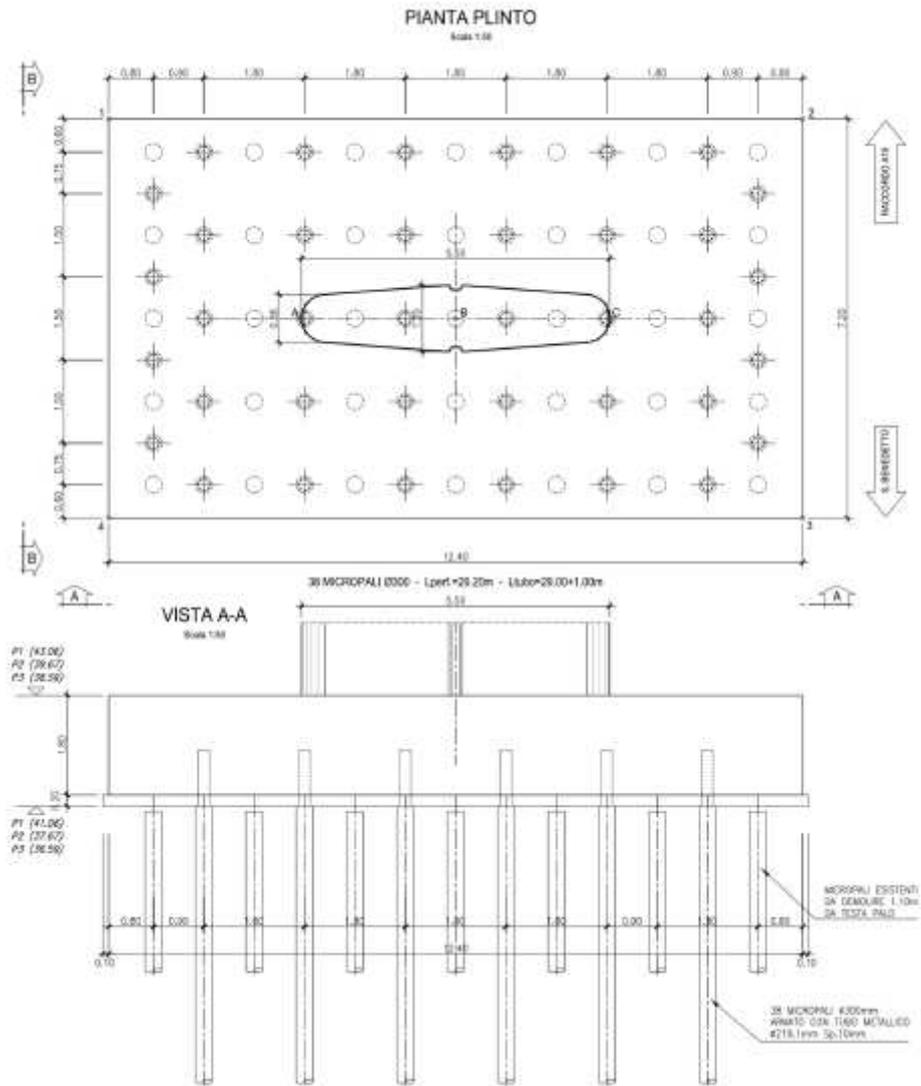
Viadotto S.Venerio I – Fondazioni Pile
